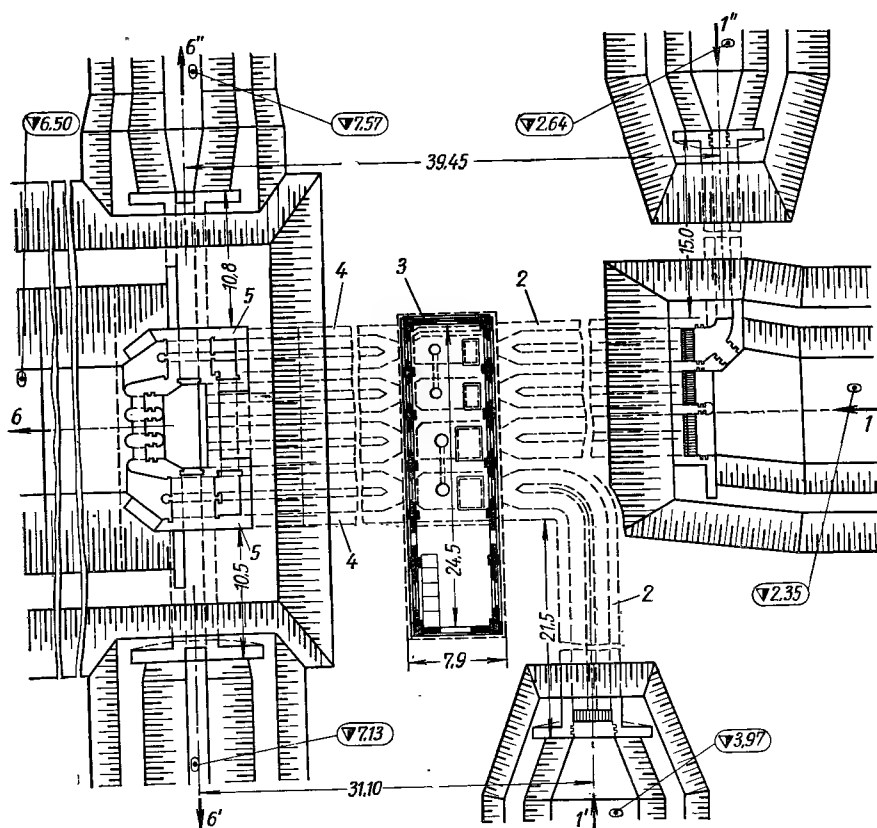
План гидротехнического узла сооружений осушительной насосной станции для откачки сбросных вод с оросительной системы:
